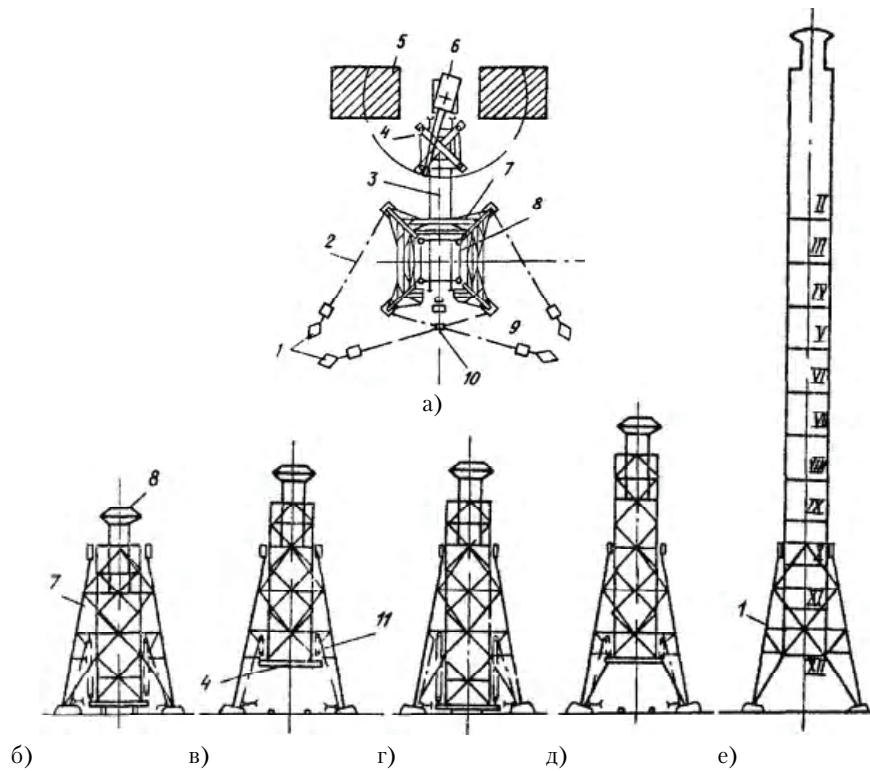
Последовательность монтажных работ при возведении вытяжной башни подращиванием: а) план; б) первоначальный этап (крановый монтаж); в) первая выдвжка; г) стыковка укрупненного блока с ранее смонтированными частями призматического ствола башни; д) очередная выдвжка с помощью тяговых полиспастов; е) очередность укрупнительной сборки и монтажа вытяжной башни; 1 – электролебедки с якорями; 2 – канат тягового полиспаста; 3 – рельсовые пути надвжки укрупненных блоков; 4 – стенд; 5 – площадка складирования; 6 – кран; 7 – пирамидальная часть башни; 8 – призматическая часть башни с зонтом газоотводящего ствола; 9 – электролебедка подачи-возврата стенда; 10 – уравнительное звено заблокированных попарно между собой тяговых полиспастов; 11 – тяговый полиспаст.
